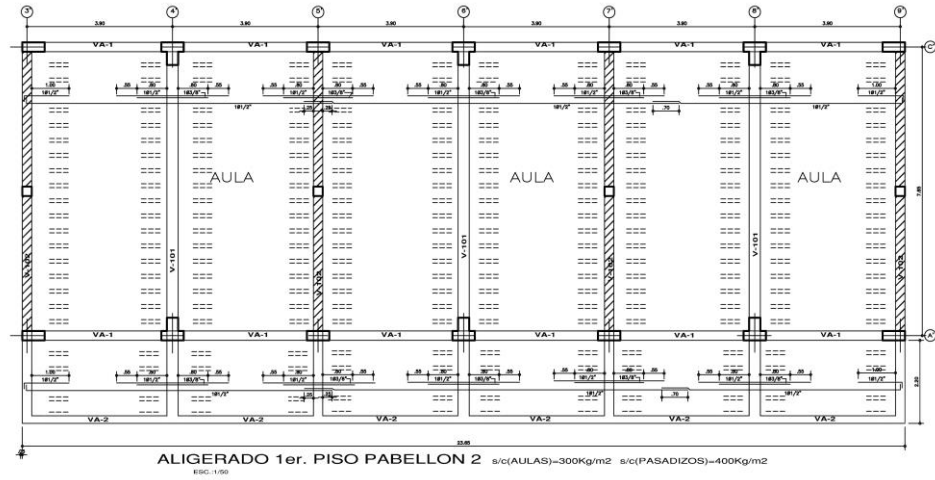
Disposición del aligerado del primer nivel del módulo 780 reforzado.
